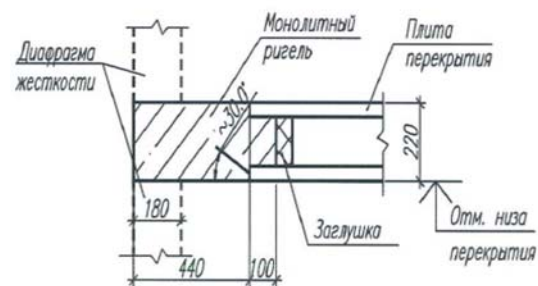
Схеми з'єднання плит перекриття із ригелем біля діафрагми / Diagrams of connection of slabs with a girder near the diaphragm
